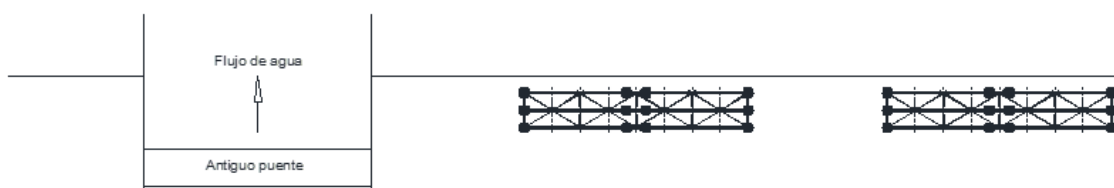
Construcción de las vigas embancadas en madera para estar más alto que el dolly
